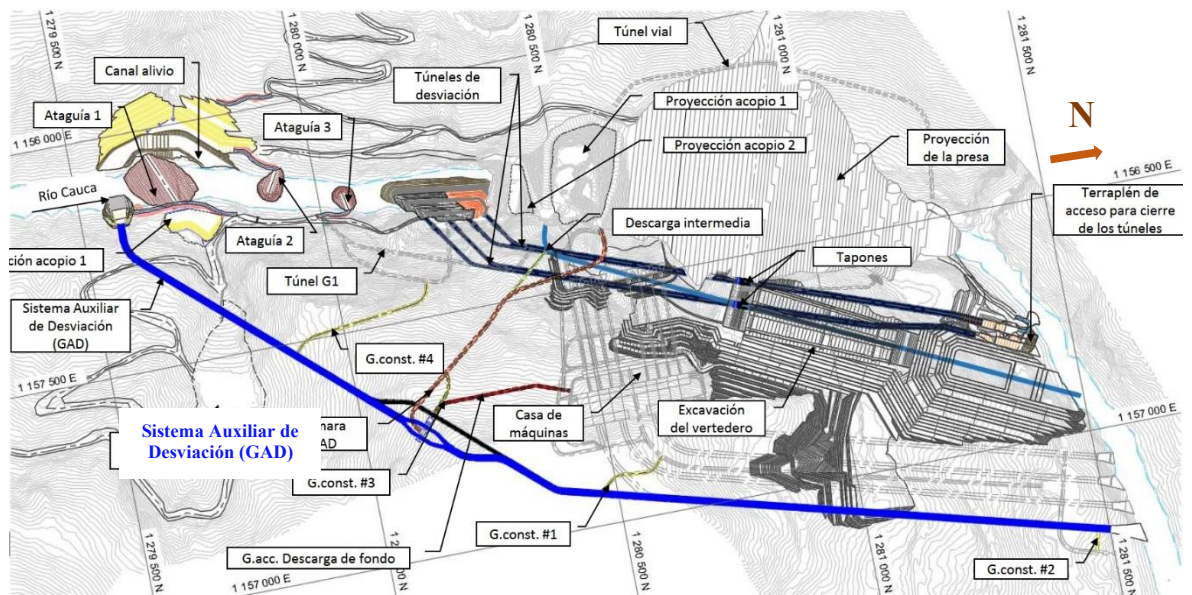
Planta donde se presenta el trazado del esquema de construcción de la Galería de Auxiliar de Desvío (GAD), además del trazado de los Túneles de Desvío Izquierdo y Derecho.
